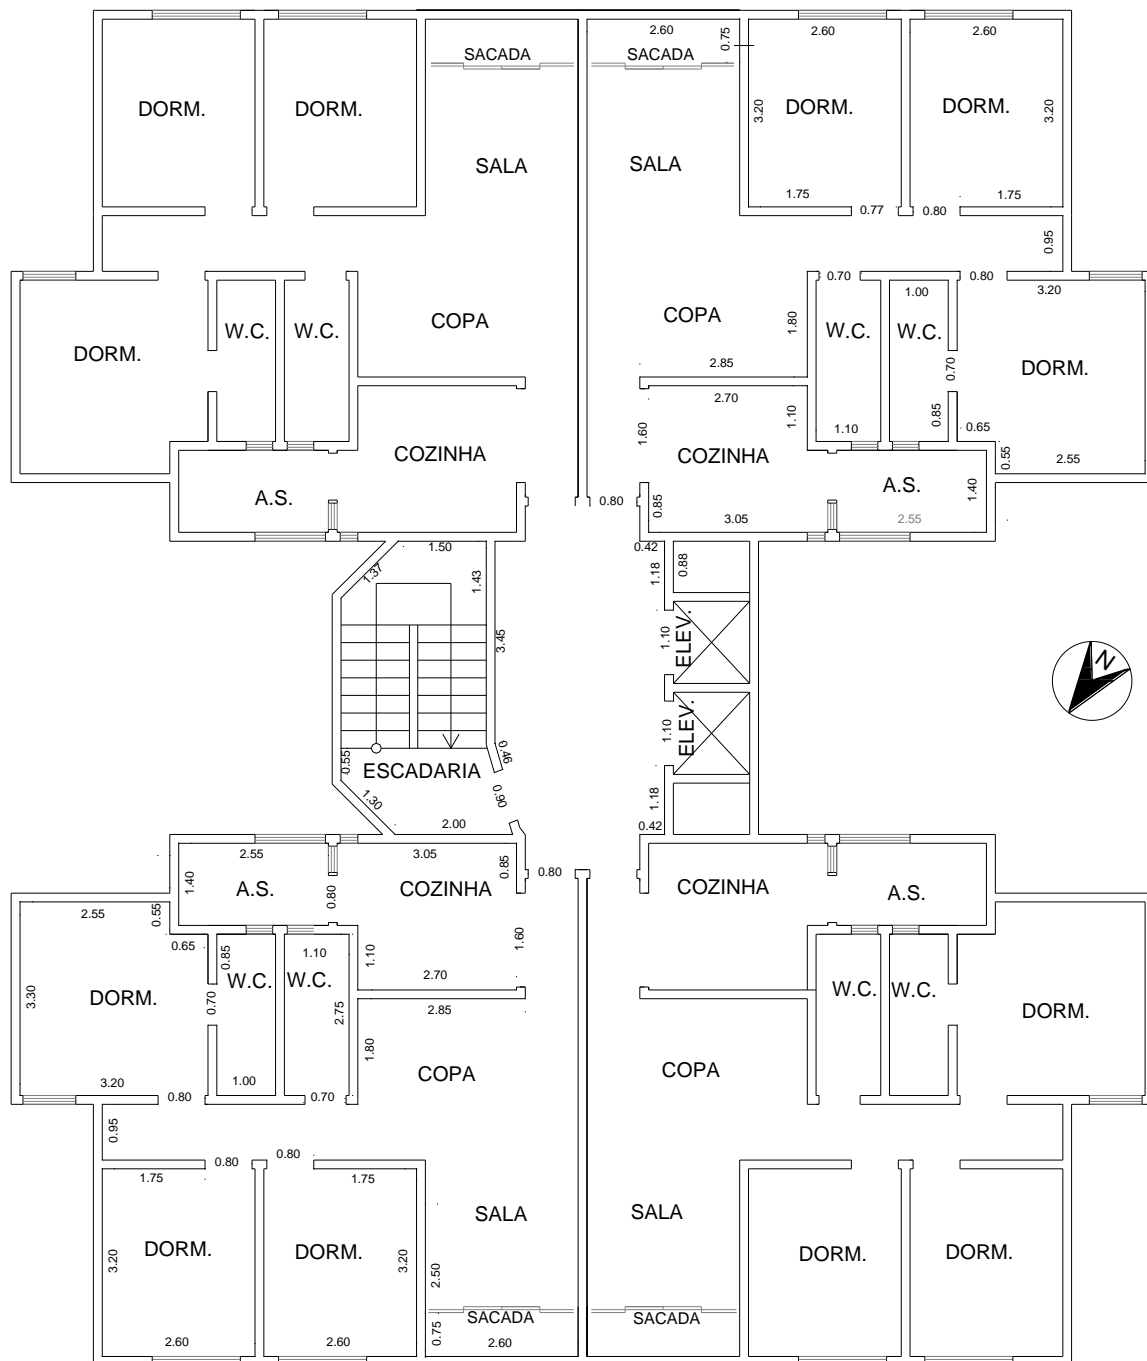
Planta do pavimento-tipo – Residencial Bôscoli.
